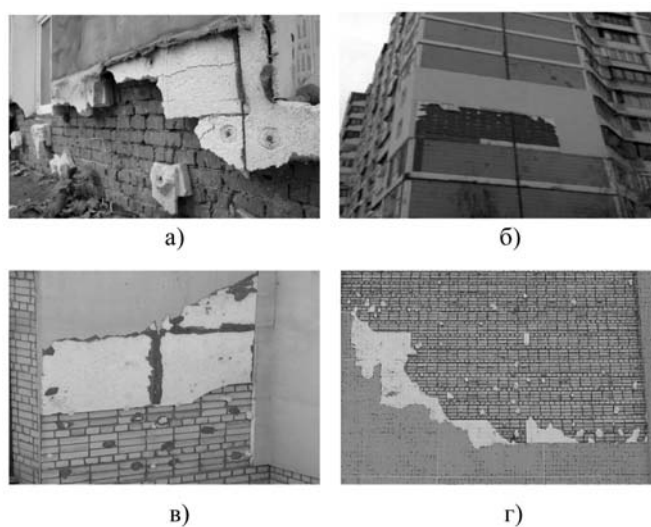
Фрагменты разрушенной системы «скрепленной теплоизоляции» на фасадах жилых зданий, утепленных пенополистирольными плитами
